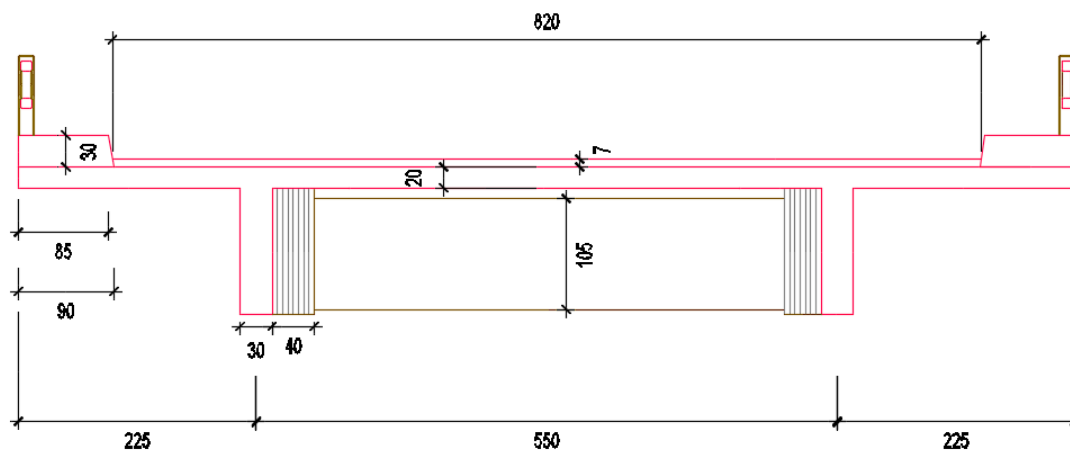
Seção transversal da ponte 1 (dimensões em cm)
